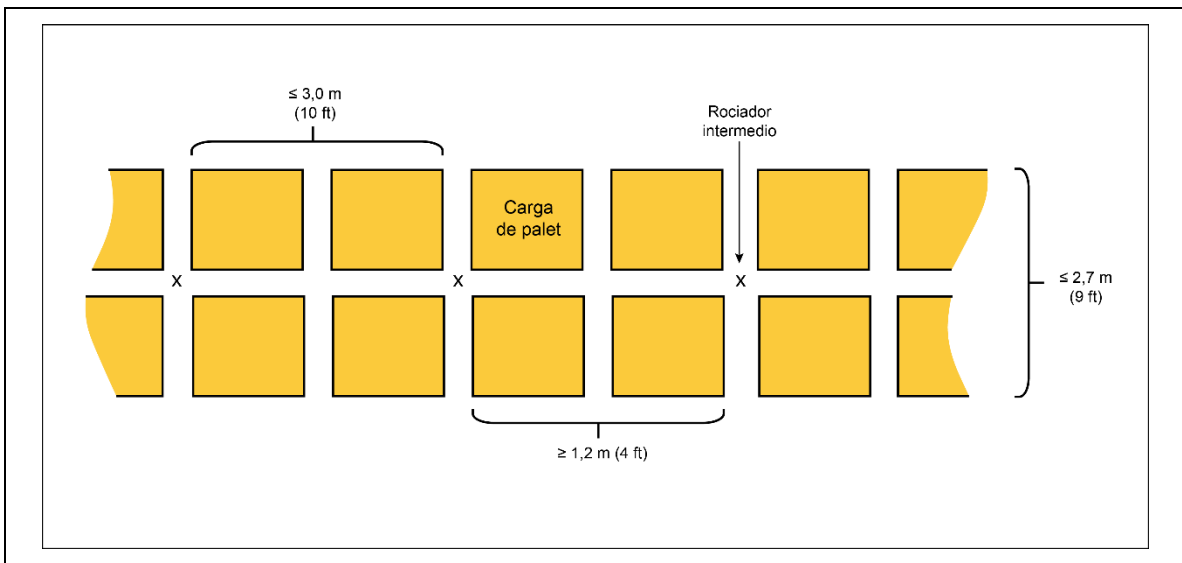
Vista en planta de una configuración horizontal de rociadores intermedios cada dos chimeneas transversales para estanterías dobles cuya profundidad sea igual o inferior a 2,7 m (9 ft)
